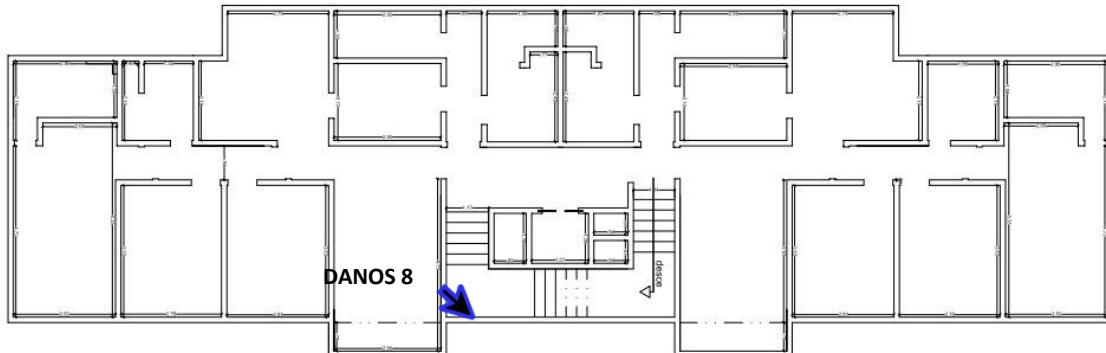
Planta Baixa (croqui) do Pavimento do 4º andar – Bloco C – Cond. Armando Lôbo.
